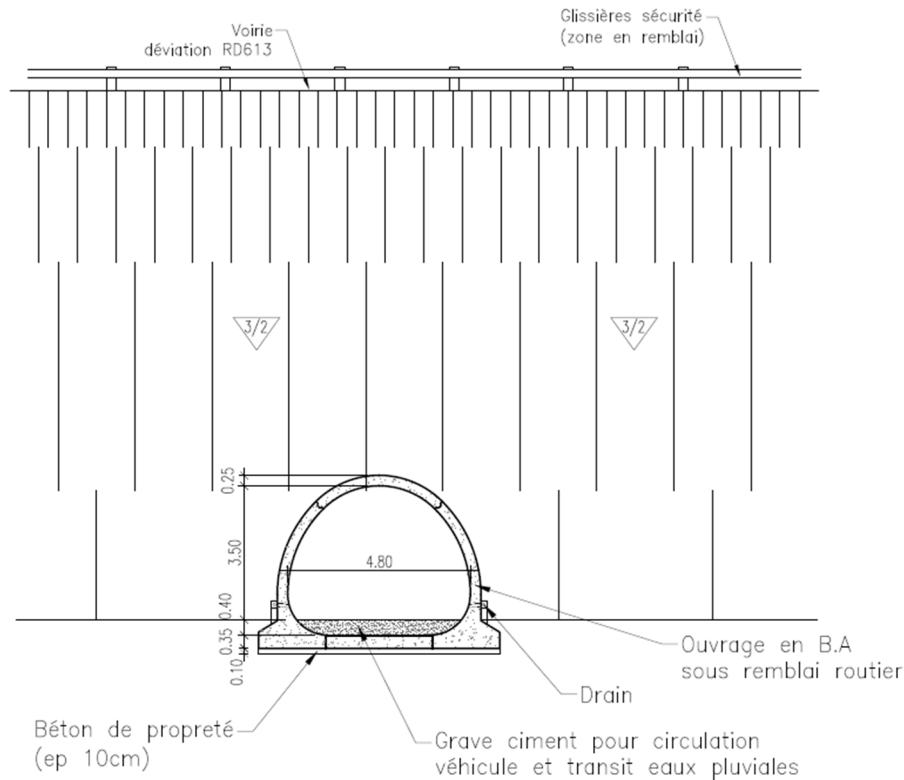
Ouvrages traversants RD613 – Coupe type Ouvrage BA
